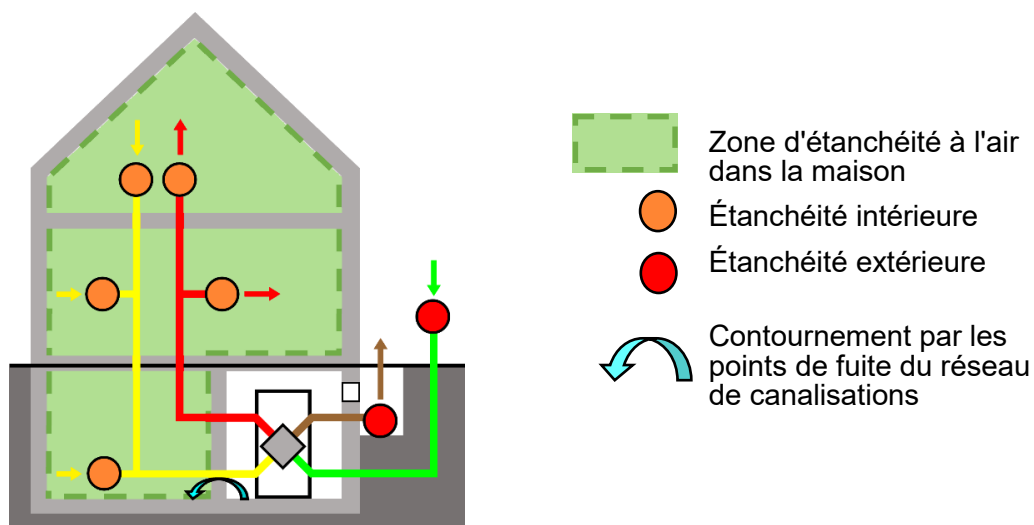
Solutions provisoires possibles pour l'étanchéité des installations de ventilation
